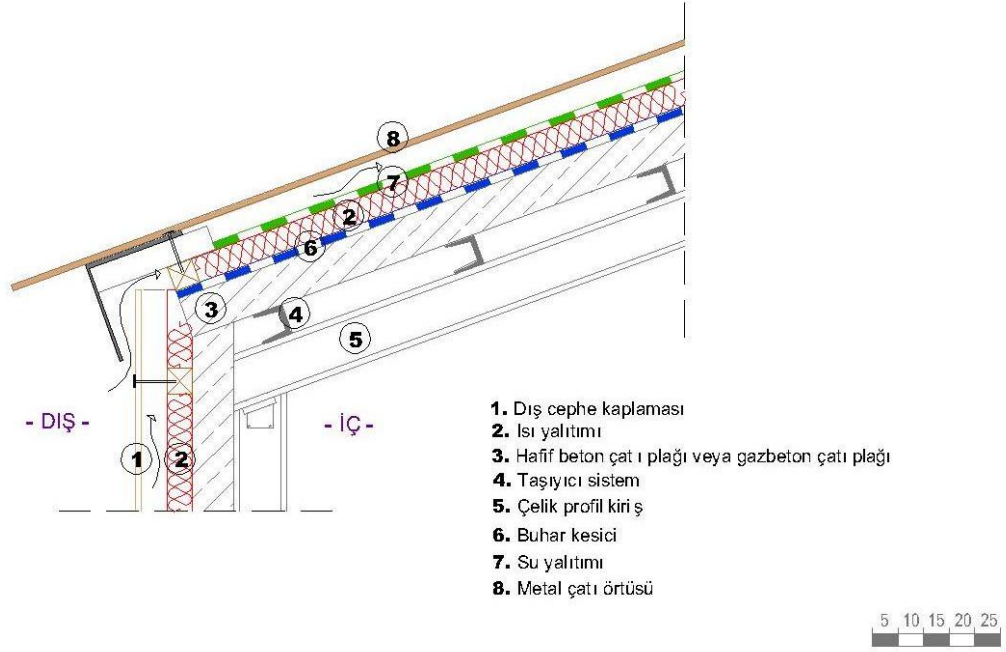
Çatı Arası Kullanılan Isı Yalıtımı Mertek-Çatı Tahtası Üzerinde Yer Alan Çatılar - Detay C4
